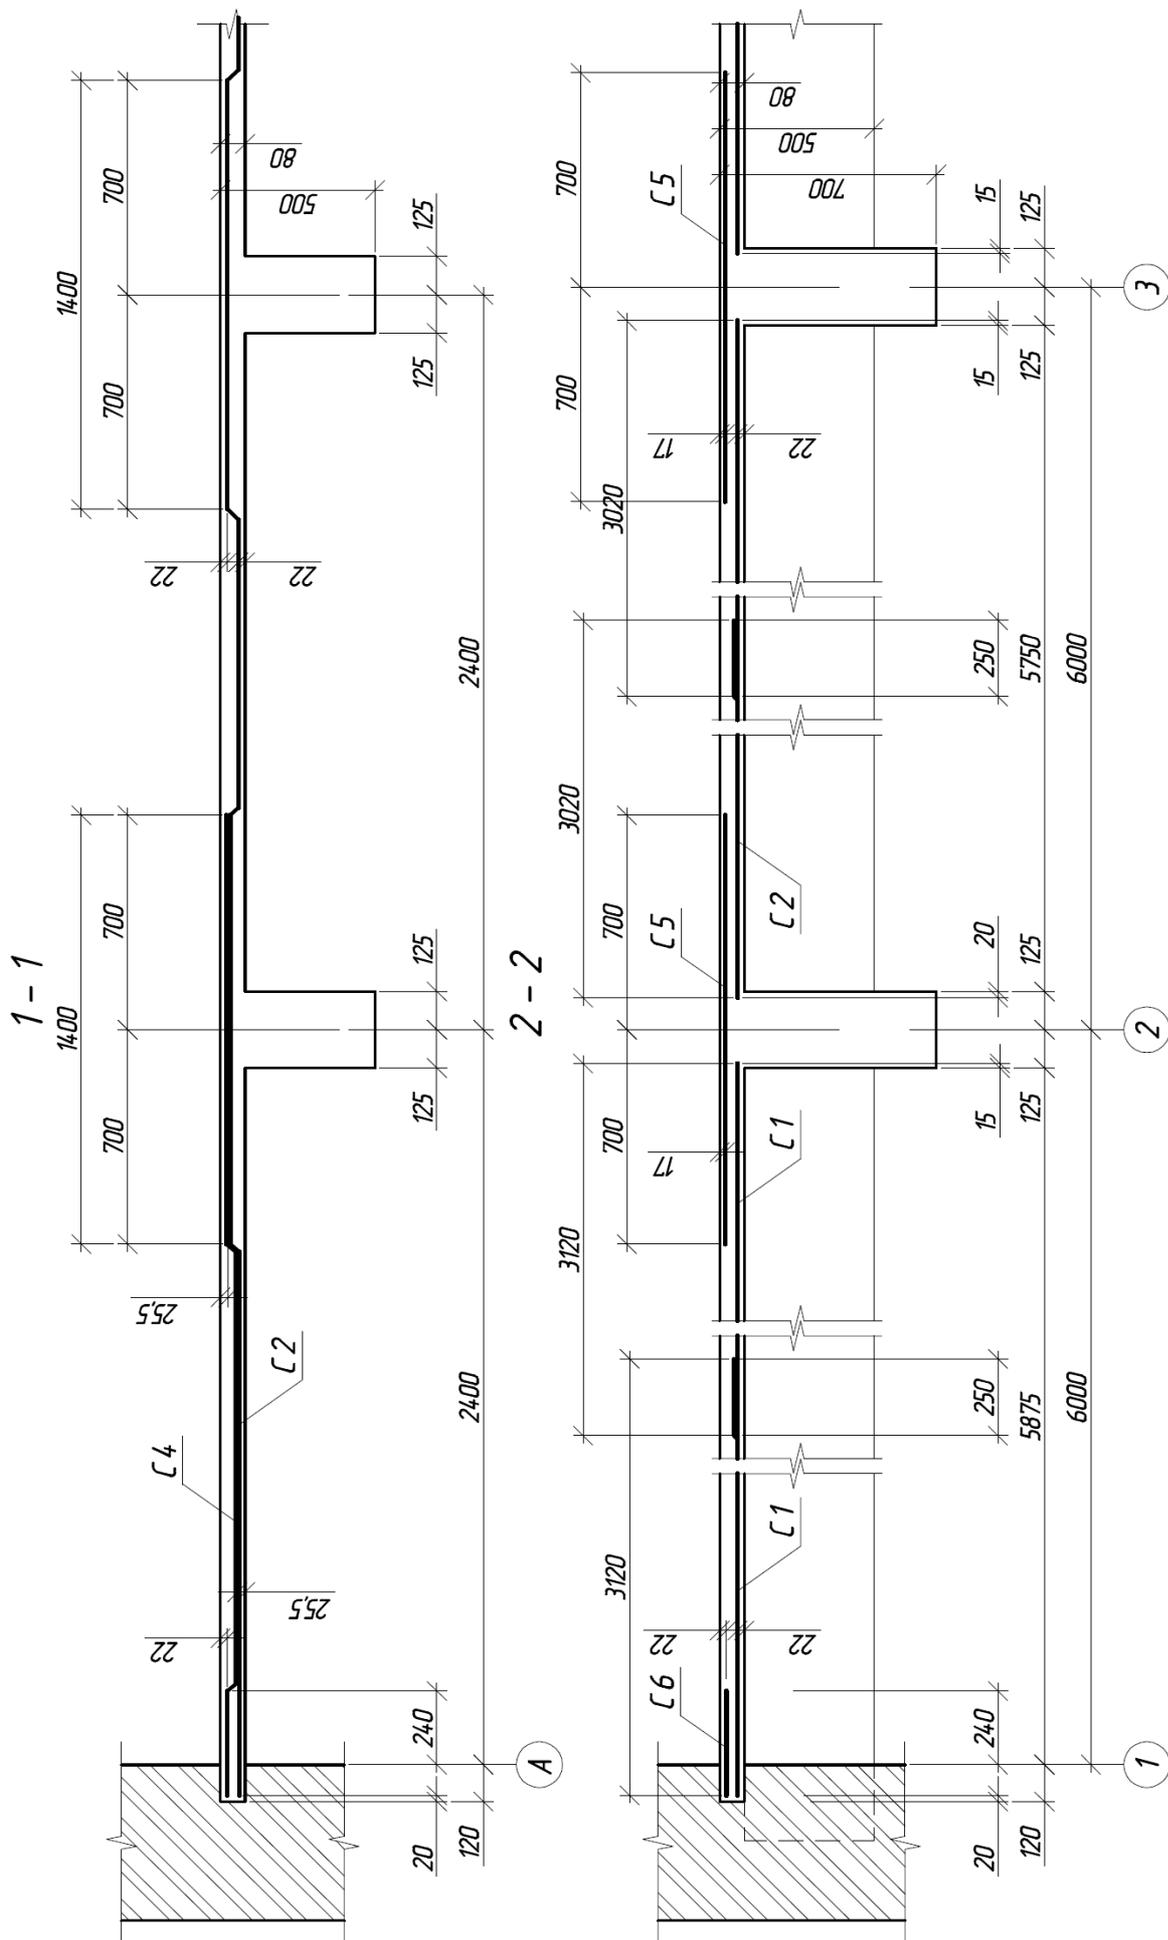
Разрезы 1-1 и 2-2 к планам верхних и нижних сеток
